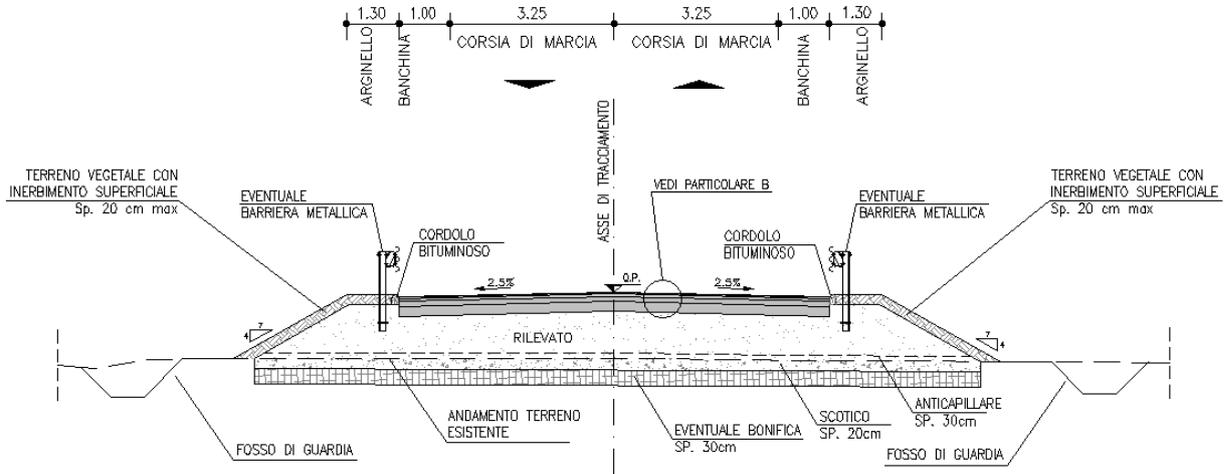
Sezione tipo Asse A, Asse B in rettilo
